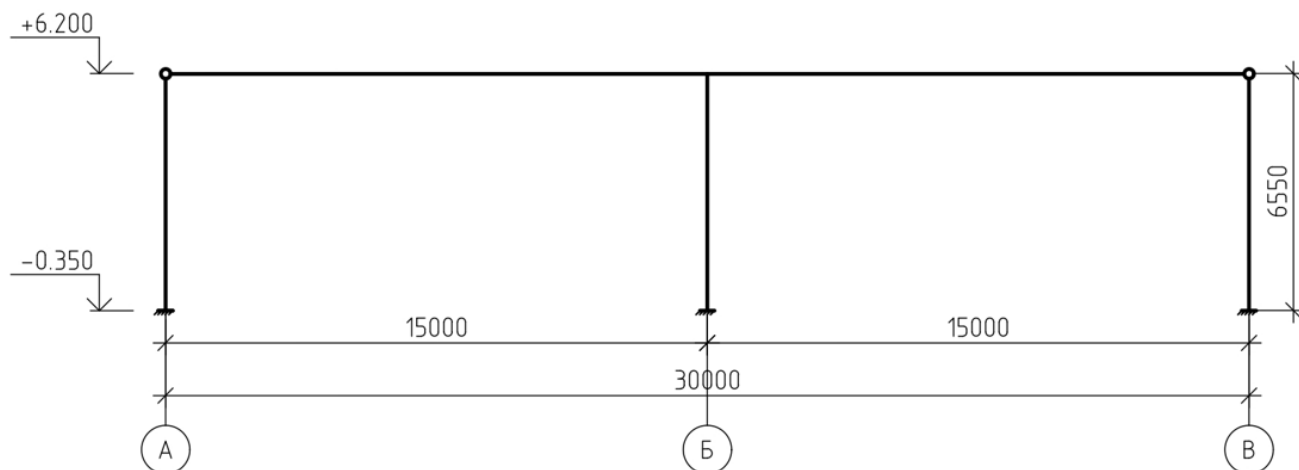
Расчётная схема поперечной рамы каркаса проектируемого здания
